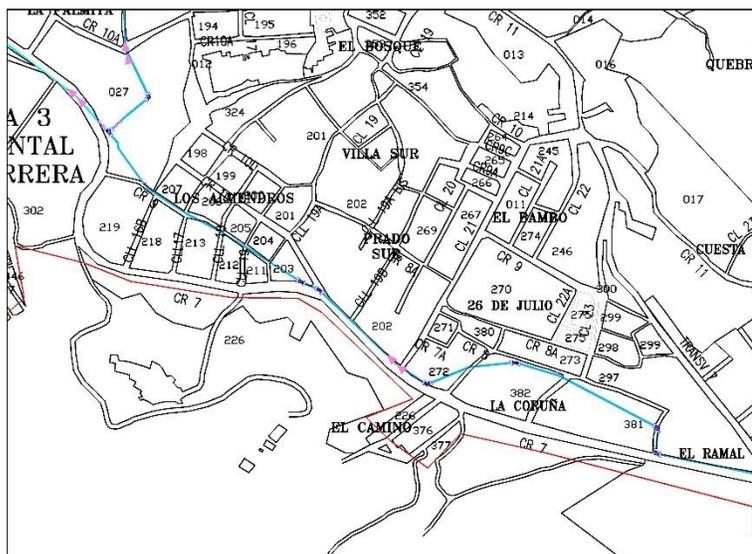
Localización en planta de la tubería de conducción El Ramal hasta la bifurcación denominado San Cayetano. Fuente: Pasante del proyecto.
